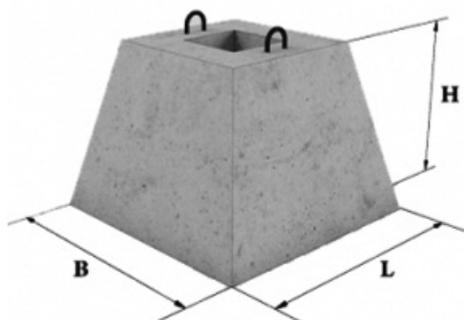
Железобетонный фундамент стаканного типа марки Ф18.9-1
